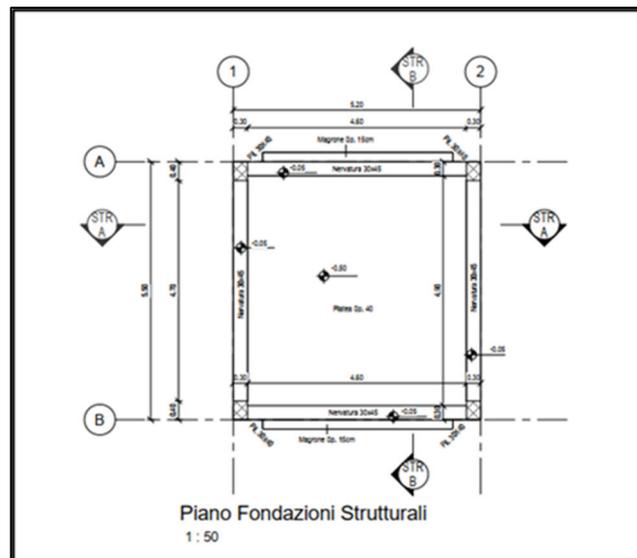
Pianta fondazioni Fabbricato servizi igienici
